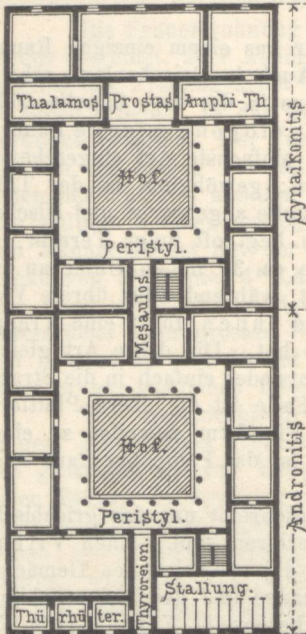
Becker's Plan eines hellenischen Wohnhauses.
